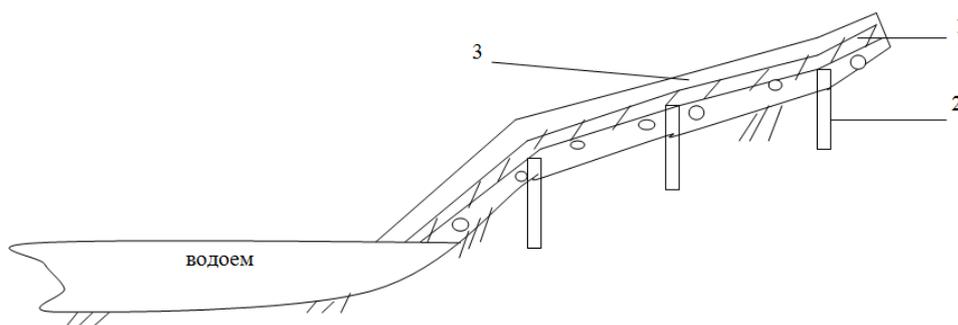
Сетка 1 укреплена на откосе буронабивных сваях 2, армированных композитной арматурой. Конструкция залита слоем бетона 3.
